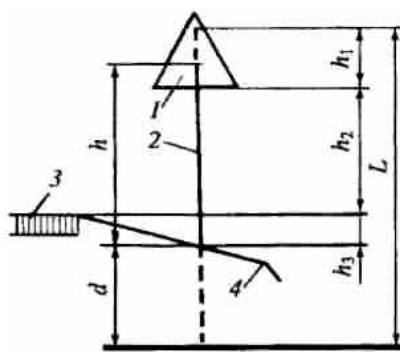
Расчетная схема опоры для установки дорожных знаков:
